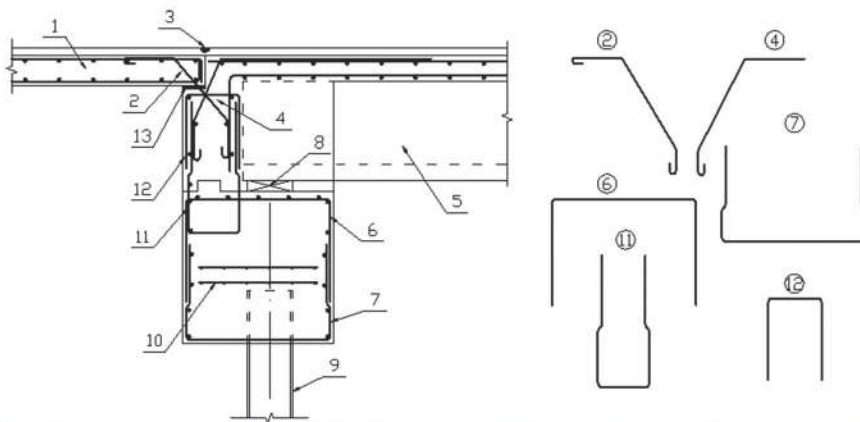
Конструкция объединения интегрального устоя с железобетонным пролетным строением и переходной плитой: 1 - переходная плита; 2 - арматура объединения переходной плиты и тела устоя; 3 - прорез в асфальтобетонном покрытии; 4 - арматура объединения плиты проезжей части и тела устоя; 5 - железобетонная балка; 6, 7 - арматура ростверка устоя; 8 - деревянная подушка; 9 - свая; 10 - арматурные сетки; 11 - арматура с выпусками; 12 - арматура тела устоя; 13 - упругая прокладка
